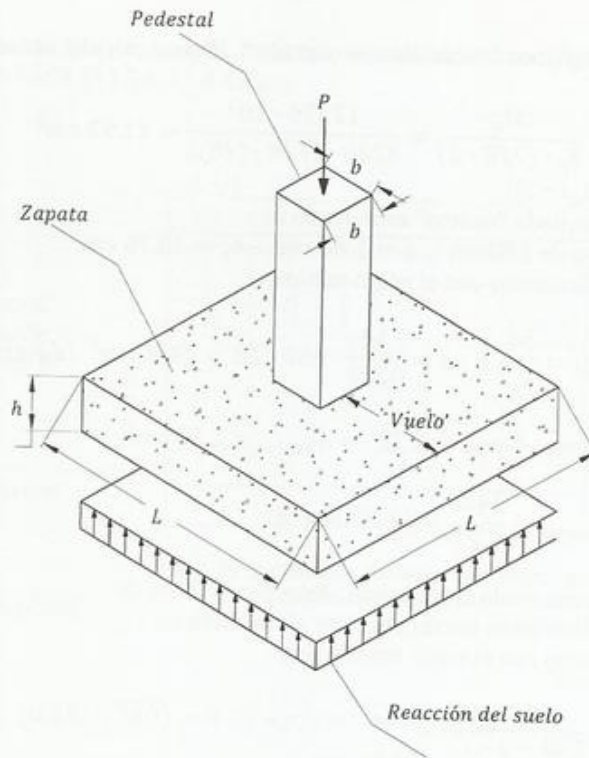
Zapata de fundación. Ejercicio 8.3
